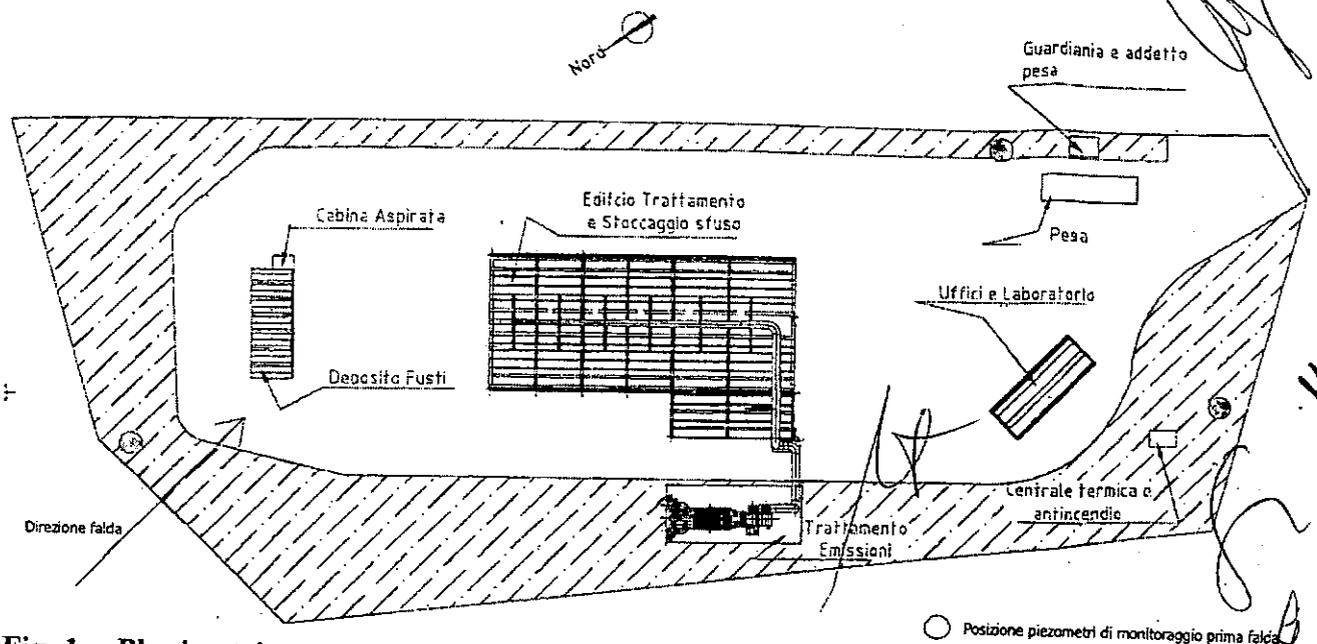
Planimetria con la distribuzione indicativa degli edifici e dei pozzi piezometrici per il monitoraggio post bonifica della falda freatica
